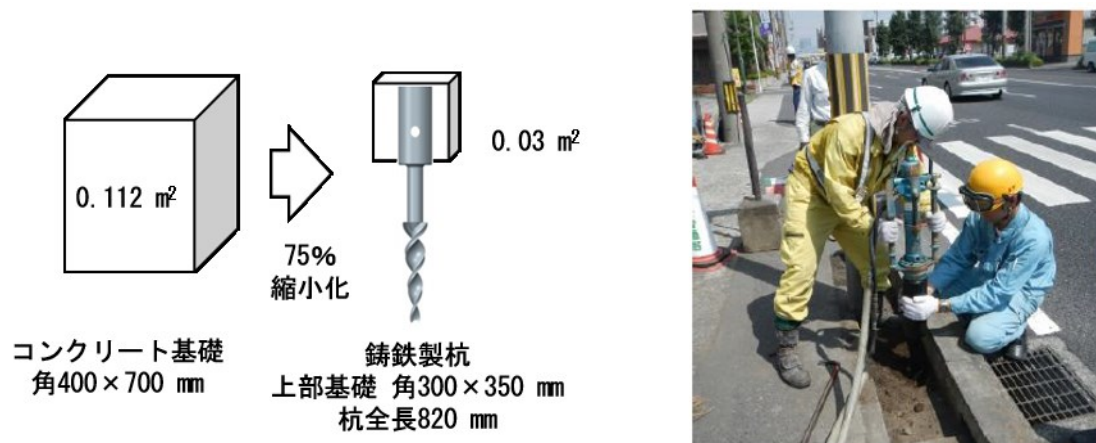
鋳鉄杭基礎構造と施工状況 ¹⁶⁾
